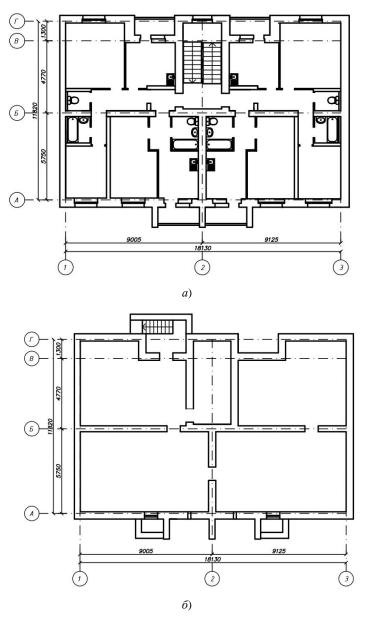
Вариант 2: a — план типового этажа; δ — план подвала
